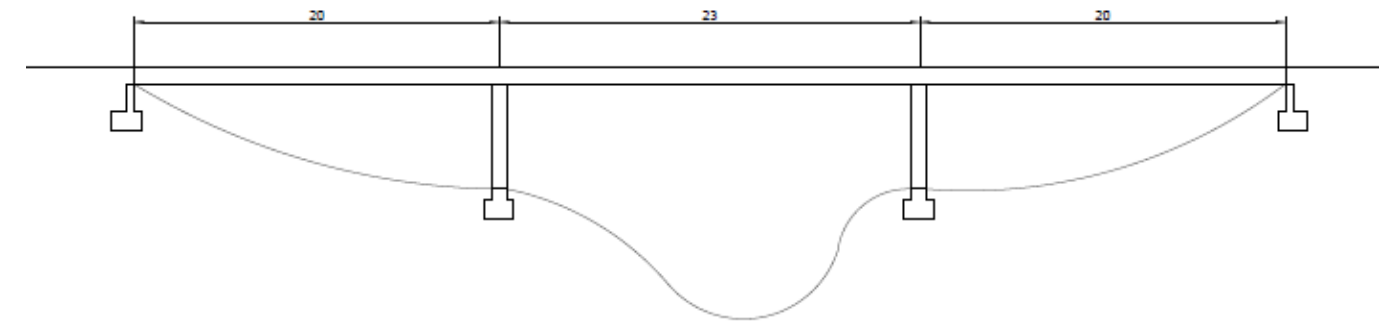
Esquema de distribución de vanos del puente sur. Fuente: Elaboración propia
